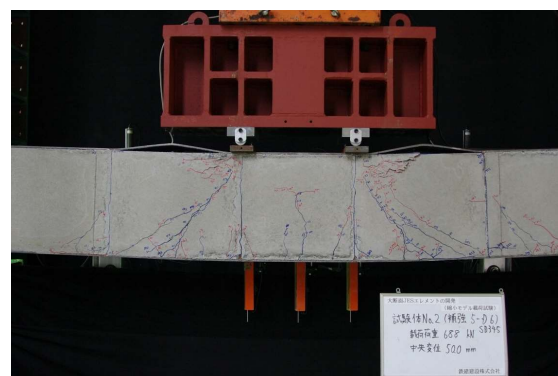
変形角 1/50 時点の損傷状況 (No. 2)
